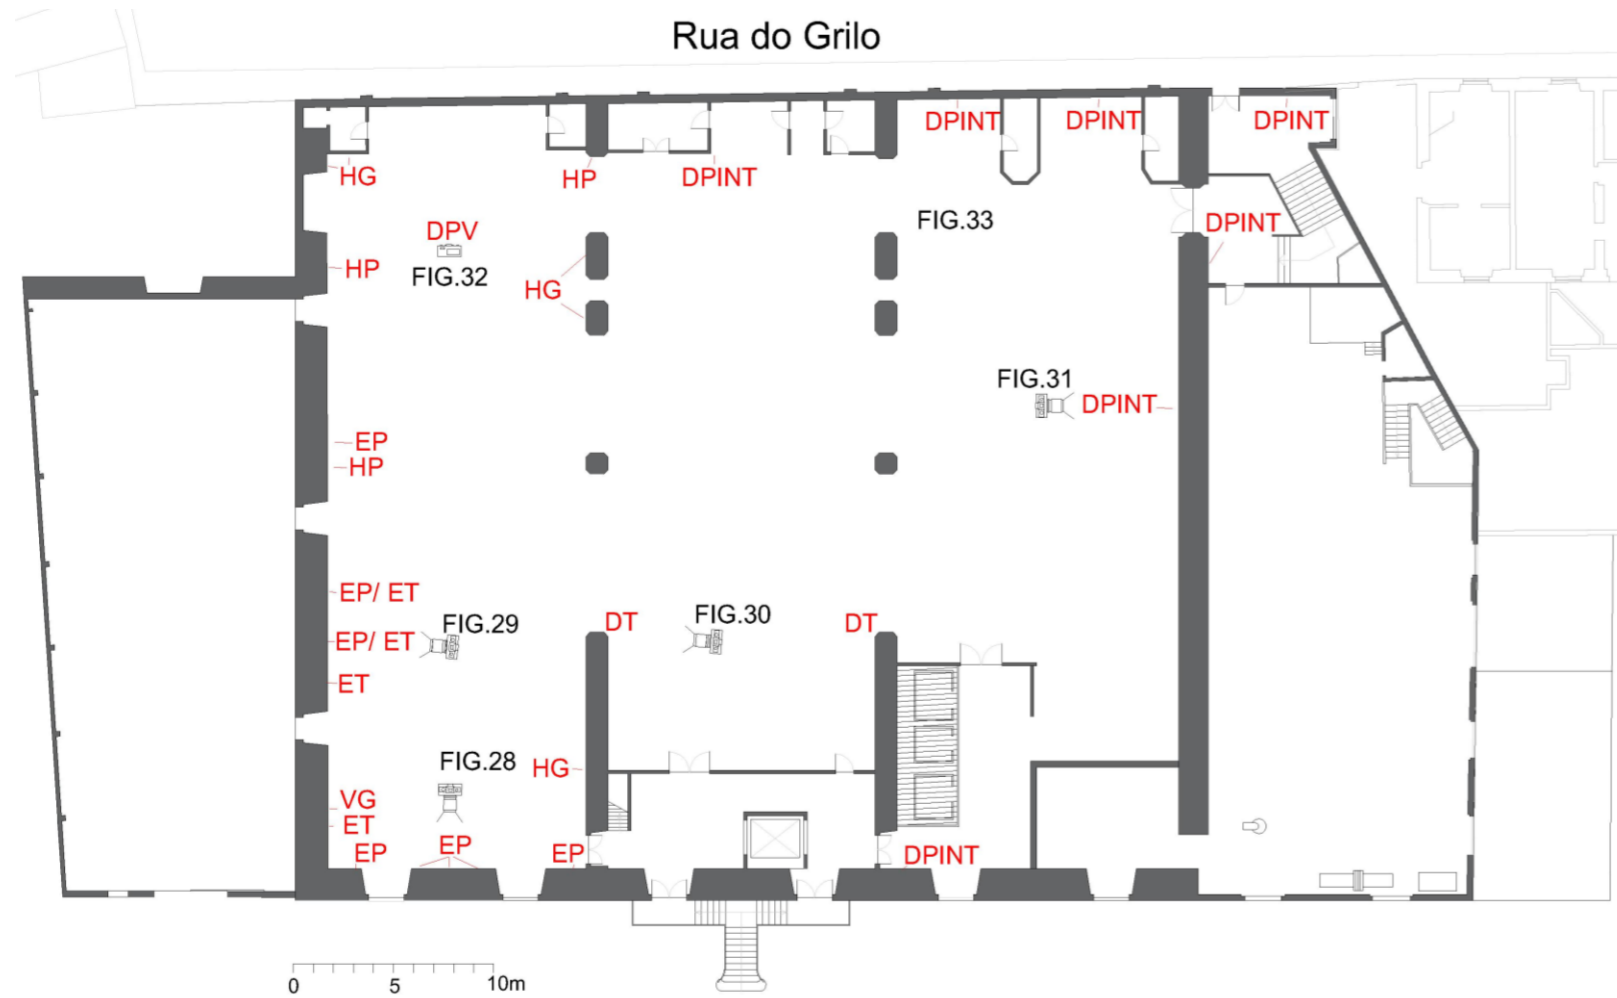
Planta de patologias do piso elevado (realizado pelo autor)
